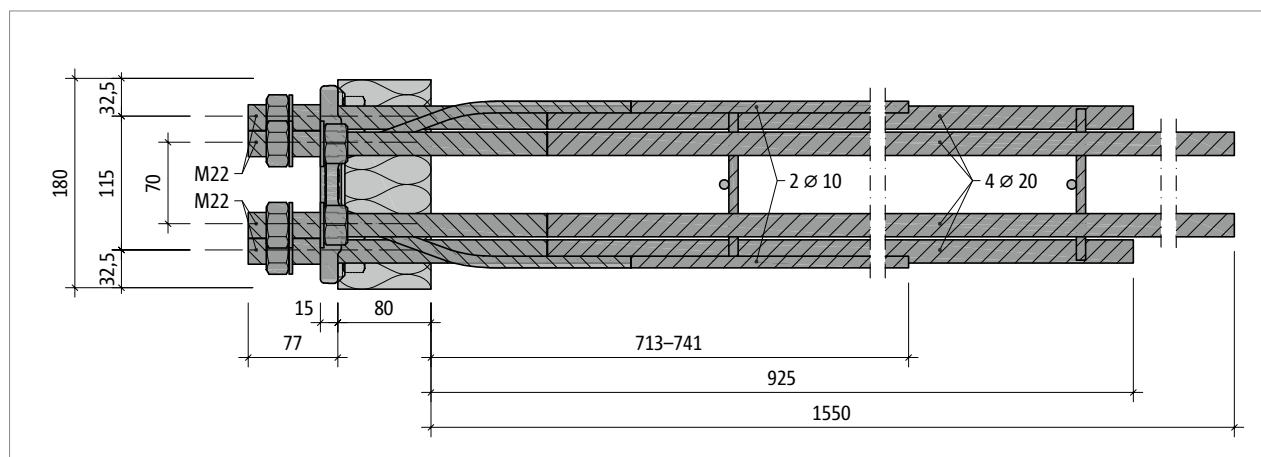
Schöck Isokorb® T type SK-MM2-VV1 : plan de base
